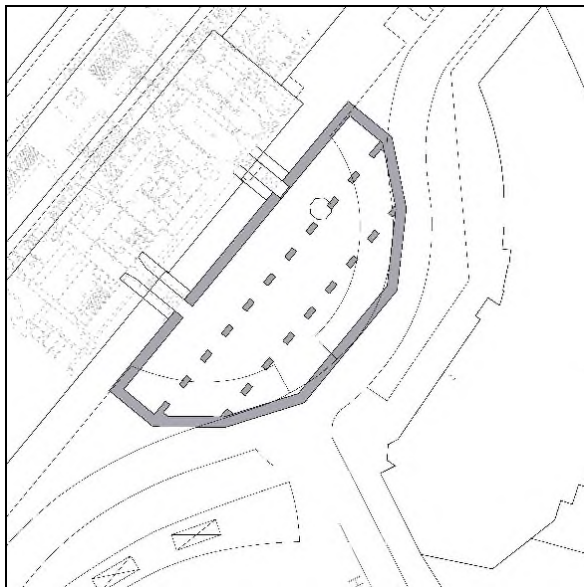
Grundriss Bunker nach Entkernung
